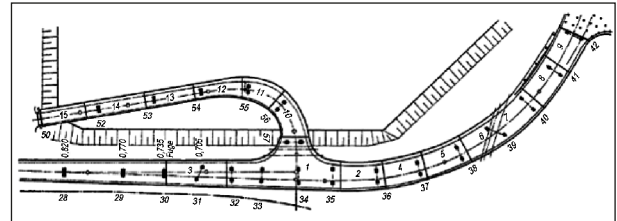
Los 1.1 mit Abfahrtsrampe Breslauer Straße (WITTFHOHT 1975)
